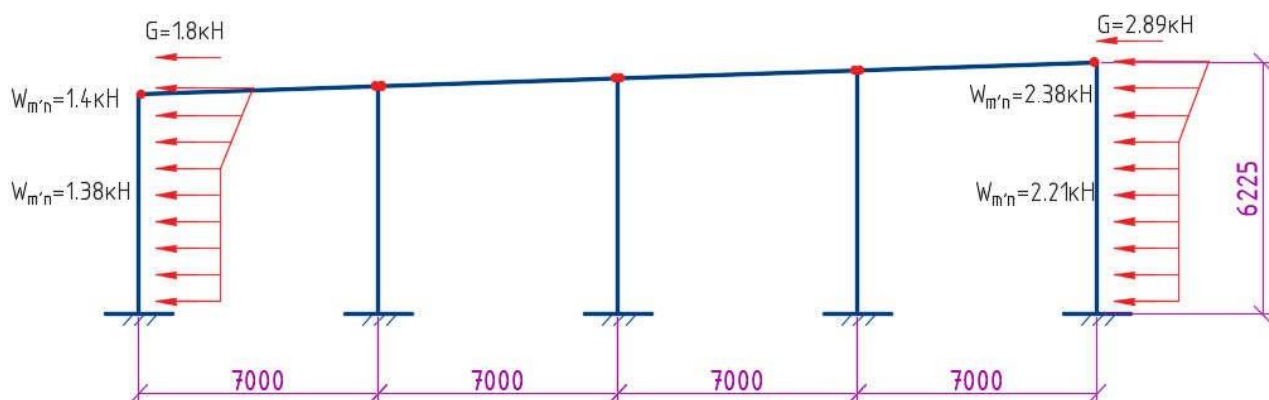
Схема загрузки от ветровой нагрузки
